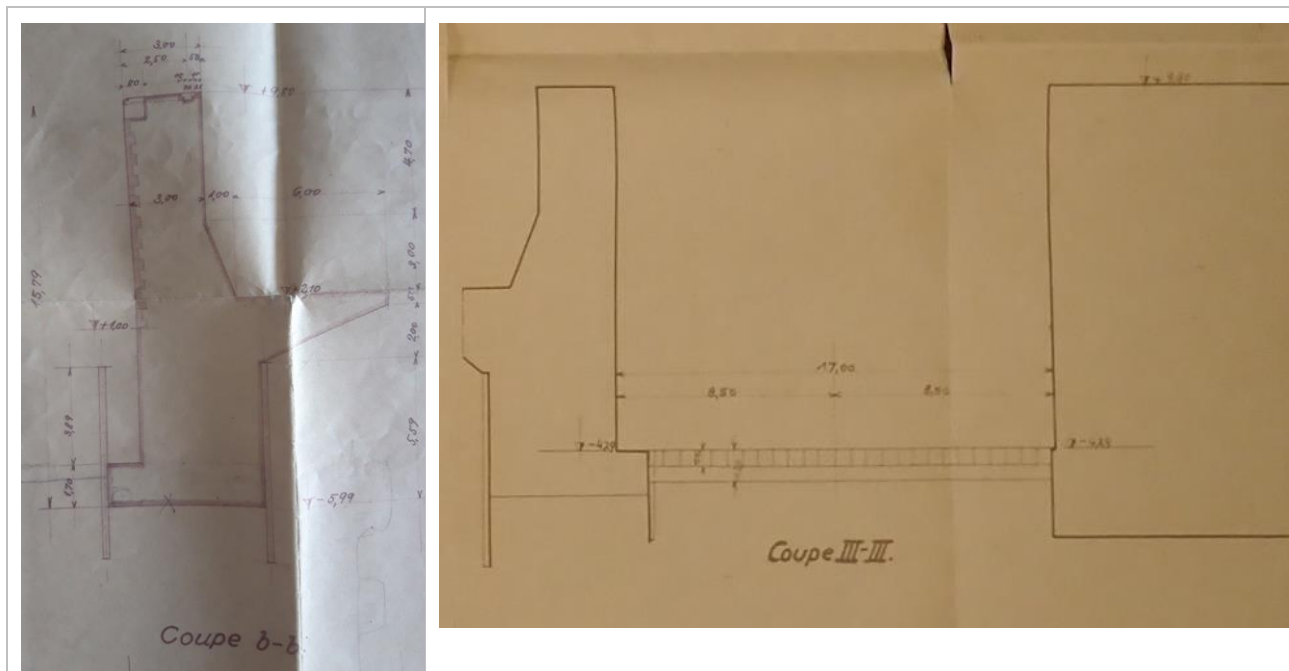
Coupe transversale du sas et du bajoyer rive droite d'après les plans d'exécution
